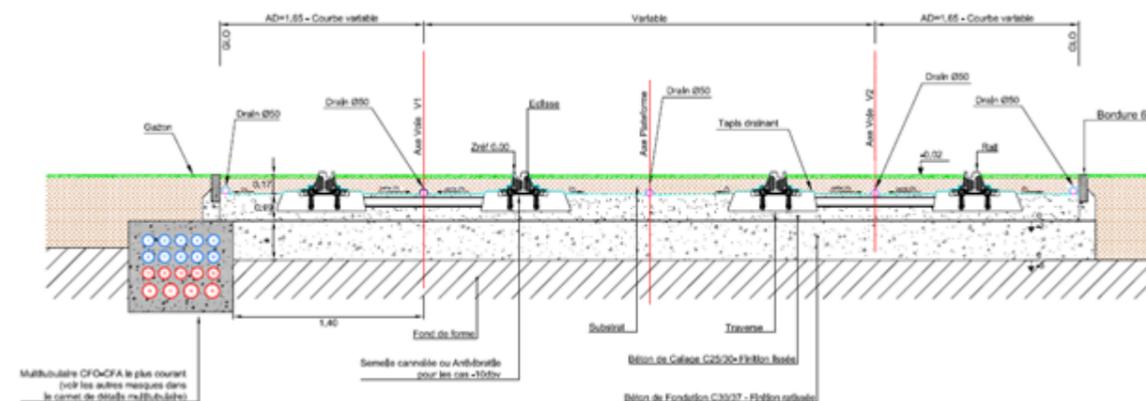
Coupe type de la pose classique sur traverses – cas d'un revêtement végétalisé, source : Études AVP - Groupement SARA
